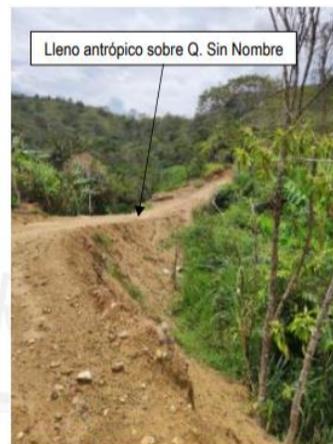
Lleno antrópico y tubería en el cauce de la quebrada Sin Nombre. Fuente: Cornare, 2024.
